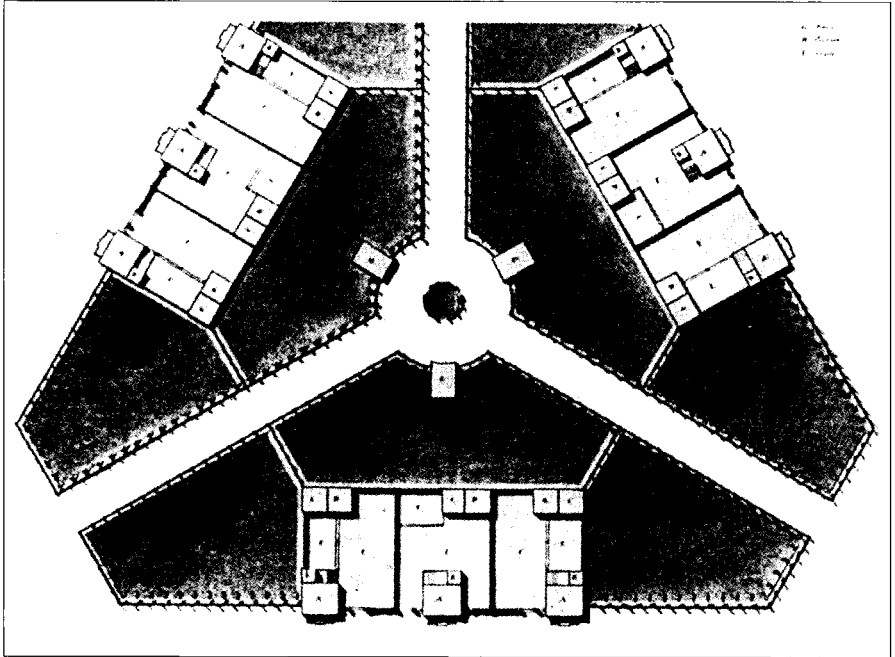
Glasowo. Grundriss, Carlo Rossi, 1815.
